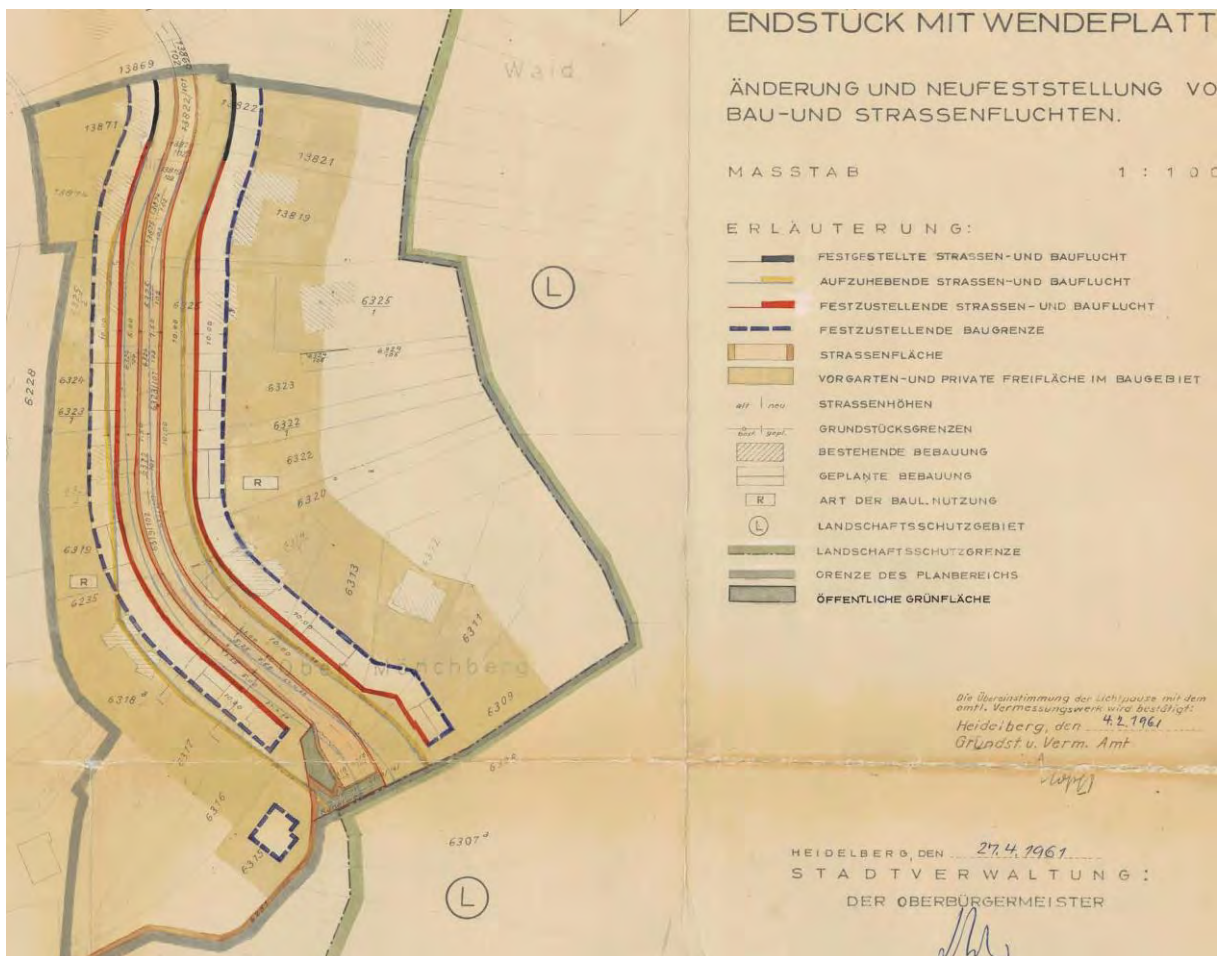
Baufuchtenplan Ludolf-Krehl-Straße
